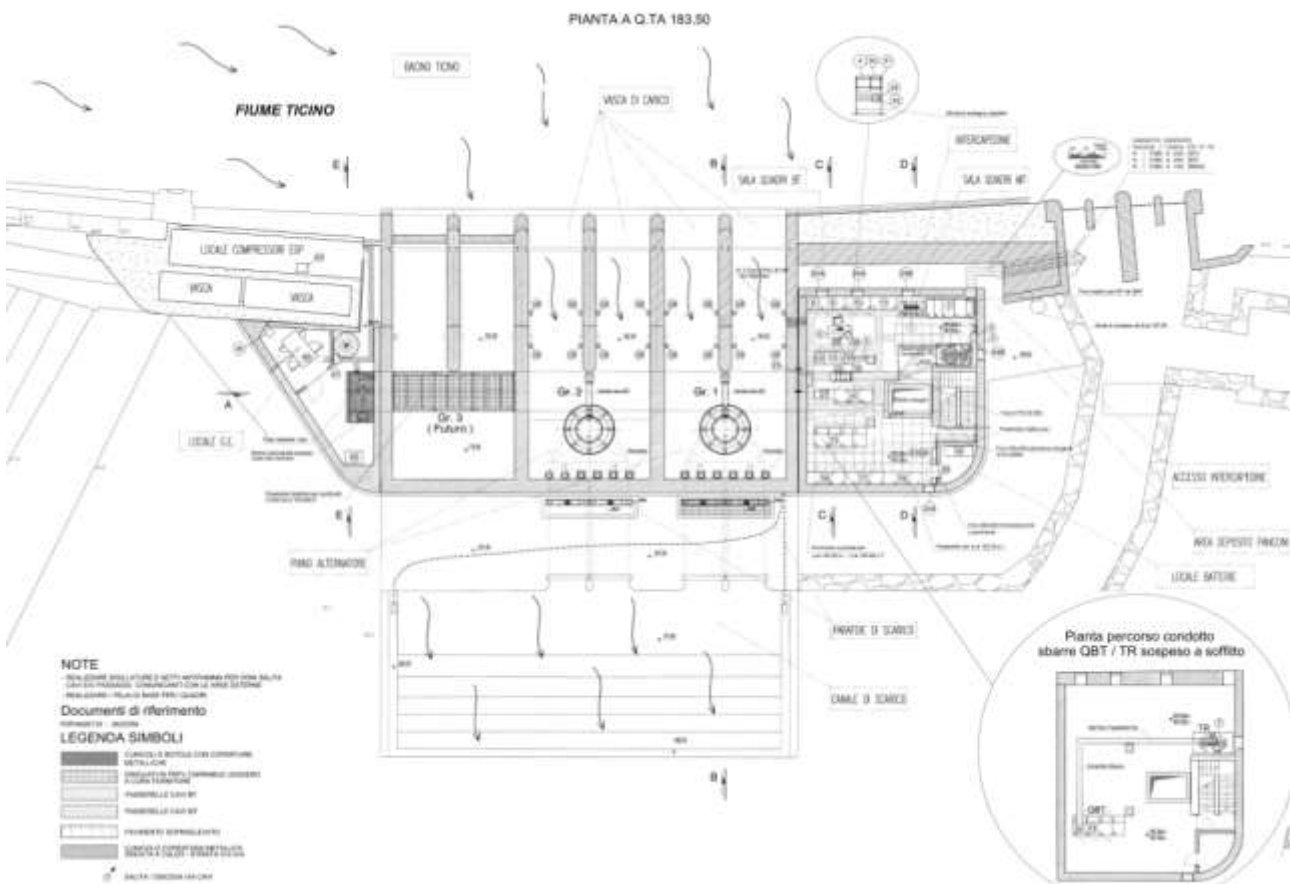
Pianta dell'impianto idroelettrico a Panperduto.
